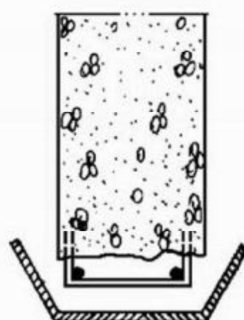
Utilização de fôrmas em vigas – Fonte: Souza e Ripper, 2009
